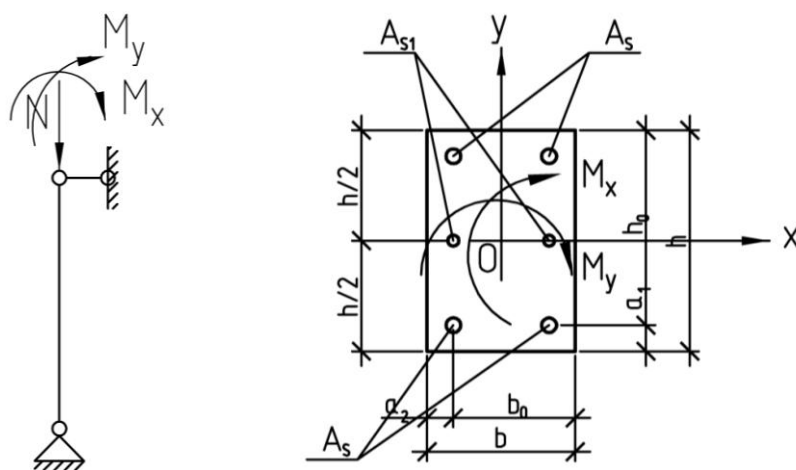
Расчётная схема железобетонного элемента, работающего на косо внецентренное сжатие
